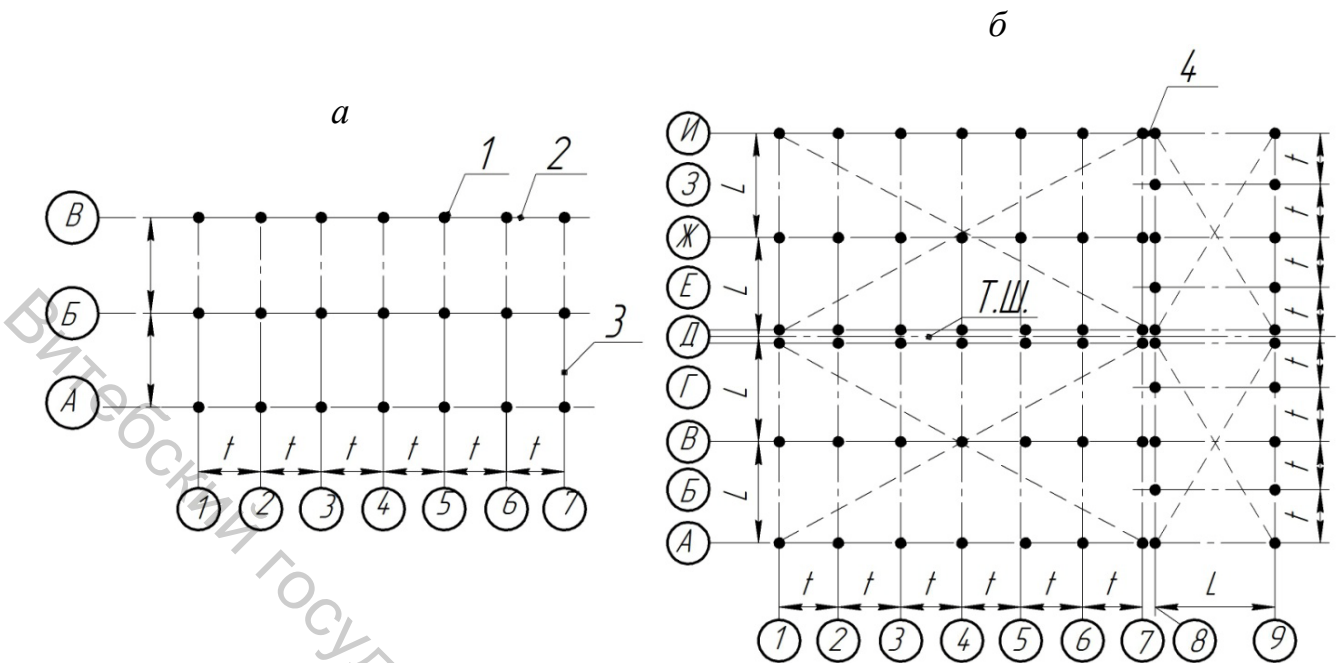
Примеры изображения схематических планов зданий:
